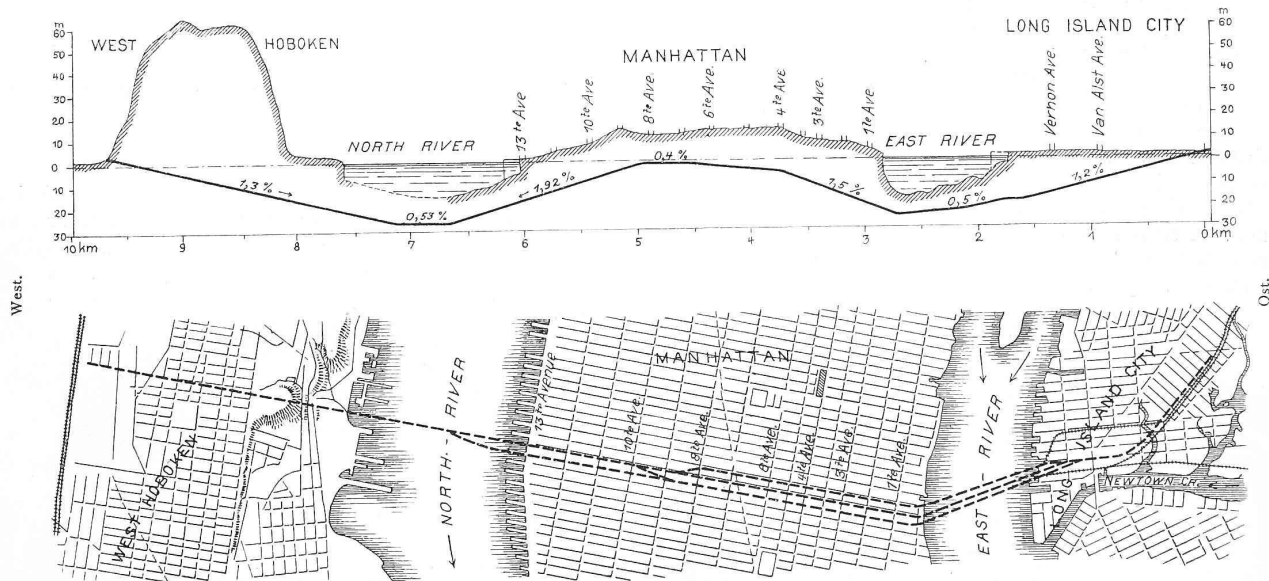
Die Tunnelanlage der Pennsylvaniabahn unter dem East River, Manhattan und dem North River. Lageplan und Längenprofil. — Masstab 1 : 60 000 für die Längen, 1 : 3 000 für die Höhen.
